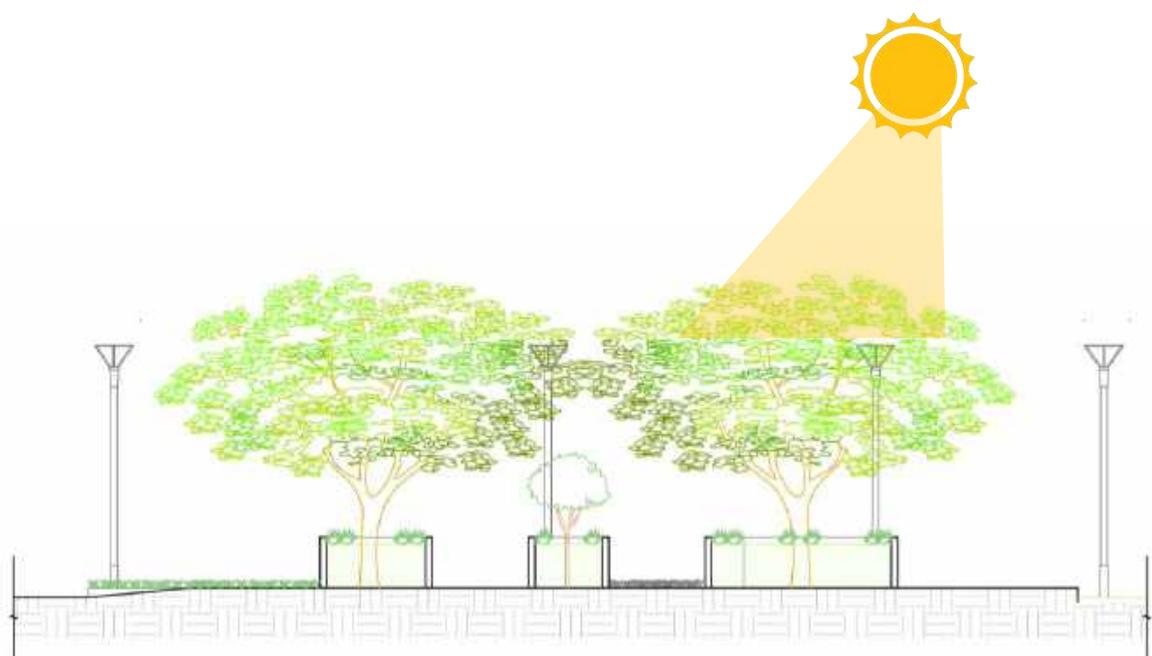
Corte de la alameda del proyecto. Elaboración propia.
